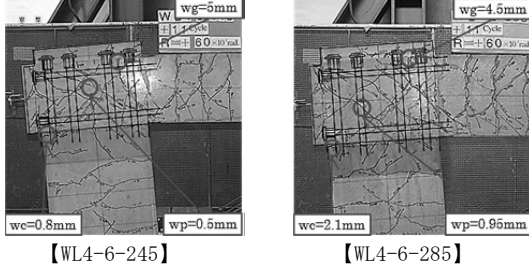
系列Iのひび割れ状況 (R=60×10<sup>-3</sup>rad時)
